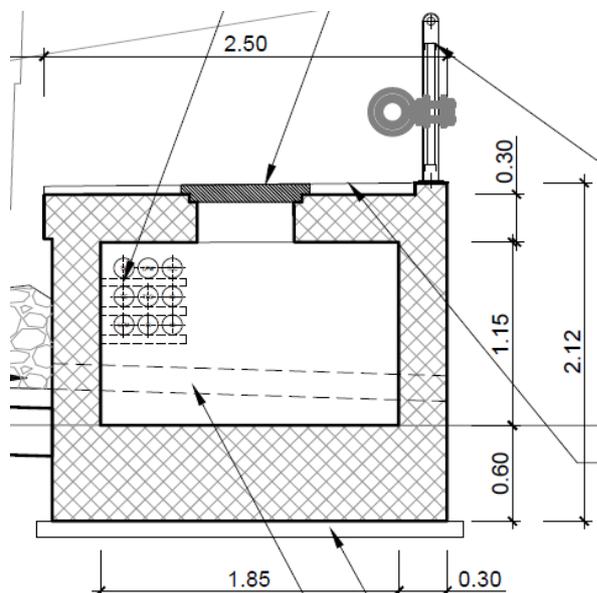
Sezione Marciapiede FFP – Tipo B (sez. n.ro – 10)
